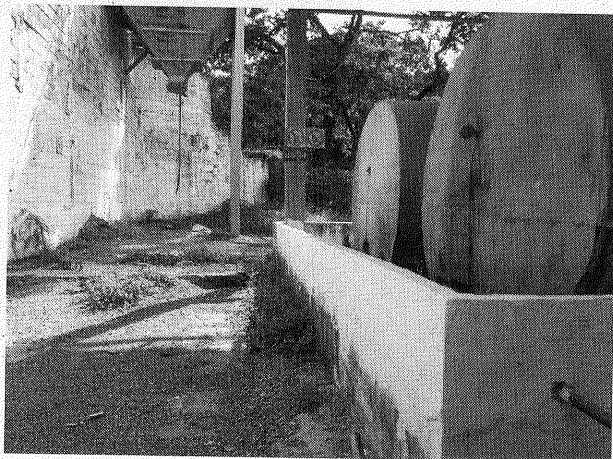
Bacia de contenção dos tanques de BPF perfurada por encanamento.
